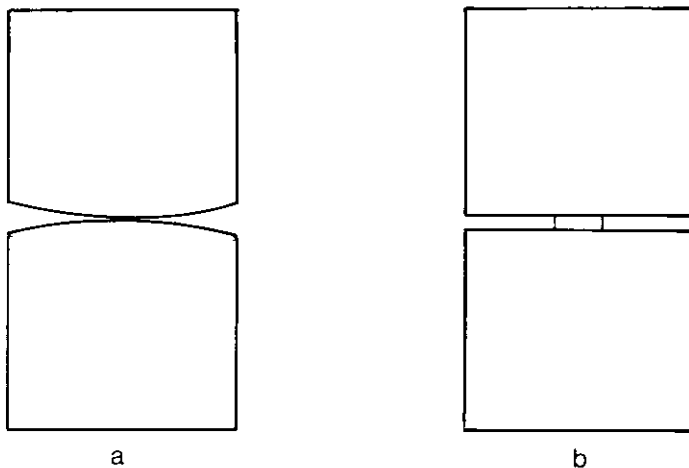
a) ARTICULAÇÃO ROLANTE
